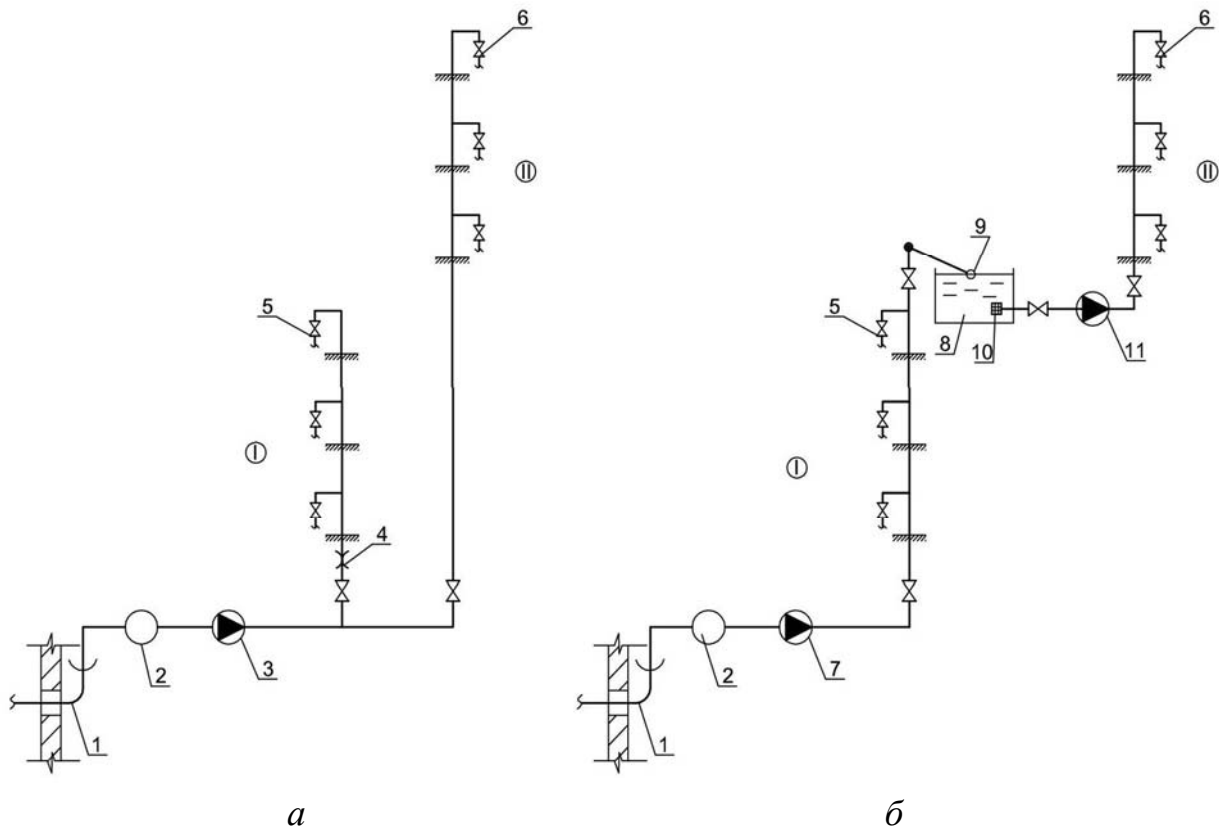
Зонні схеми внутрішнього водопроводу:
